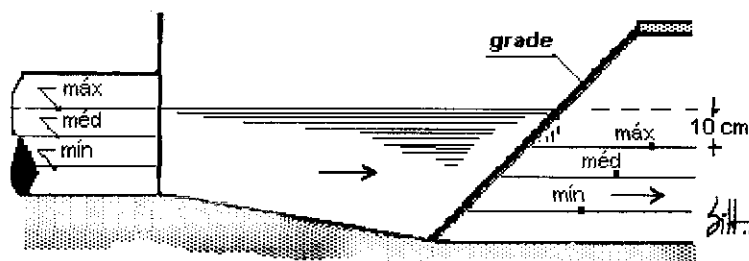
10 - Perfil esquemático das instalações de uma grade
